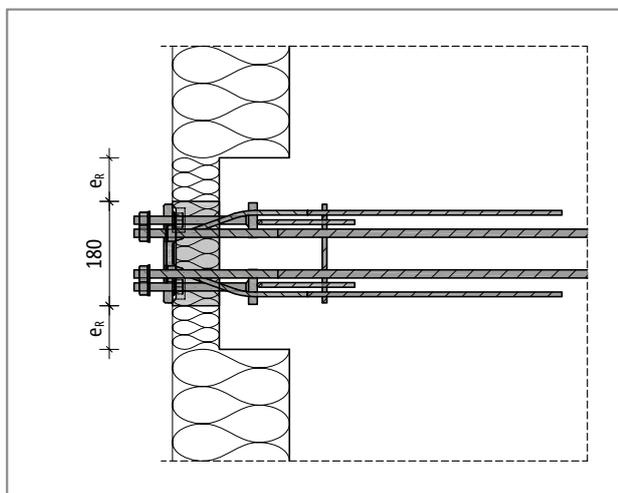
Schöck Isokorb® T tipo SKP: distanze tra i bordi
